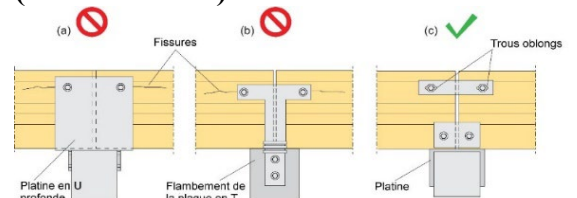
Liaison poteaux et traversés (handbook s.d.)
